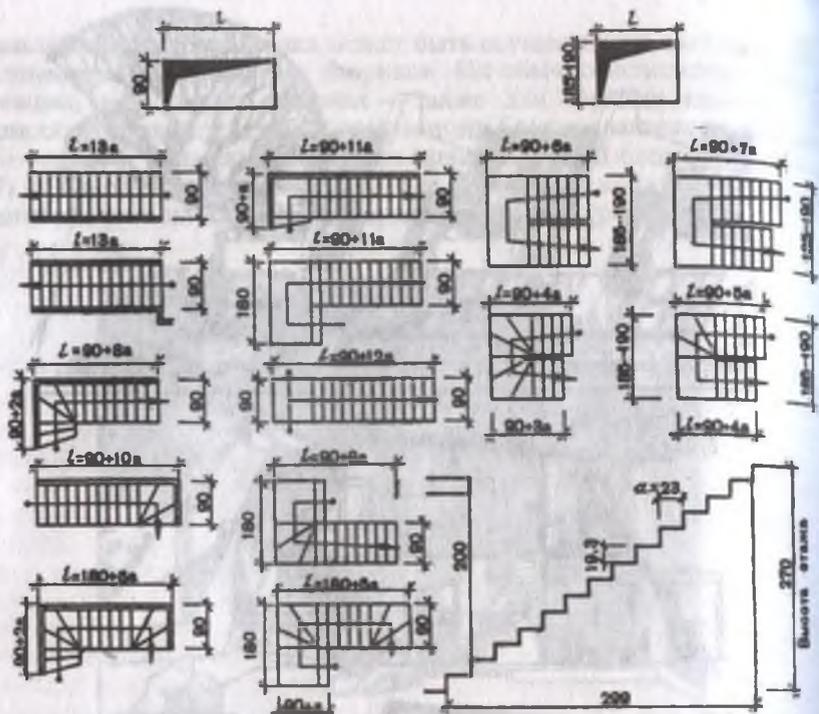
Планы внутриквартирных лестниц блокированных домов
